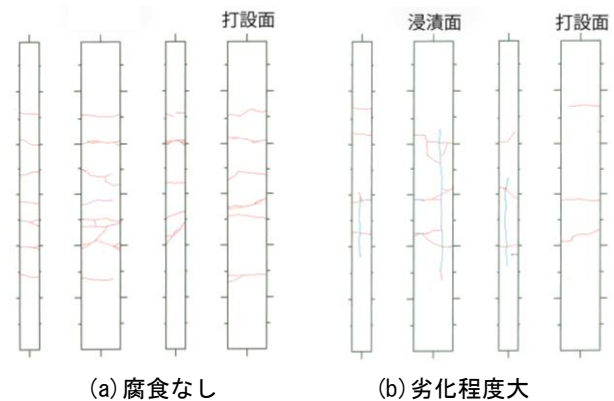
NC 供試体ひび割れ図 (C=20mm)
